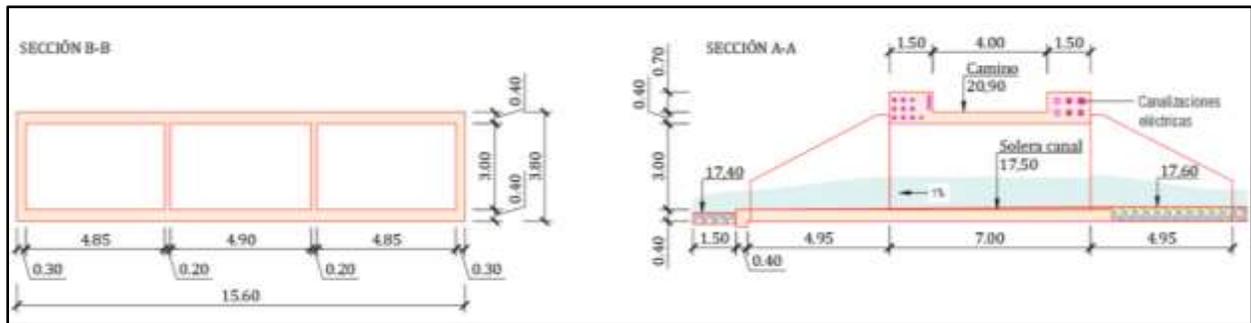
Geometría de la obra de paso. Planta y secciones principales.
